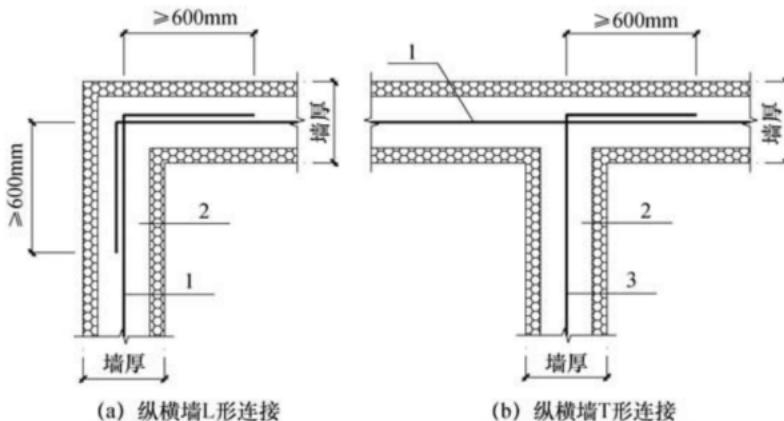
房屋墙体连接处芯孔内水平钢筋的连接
